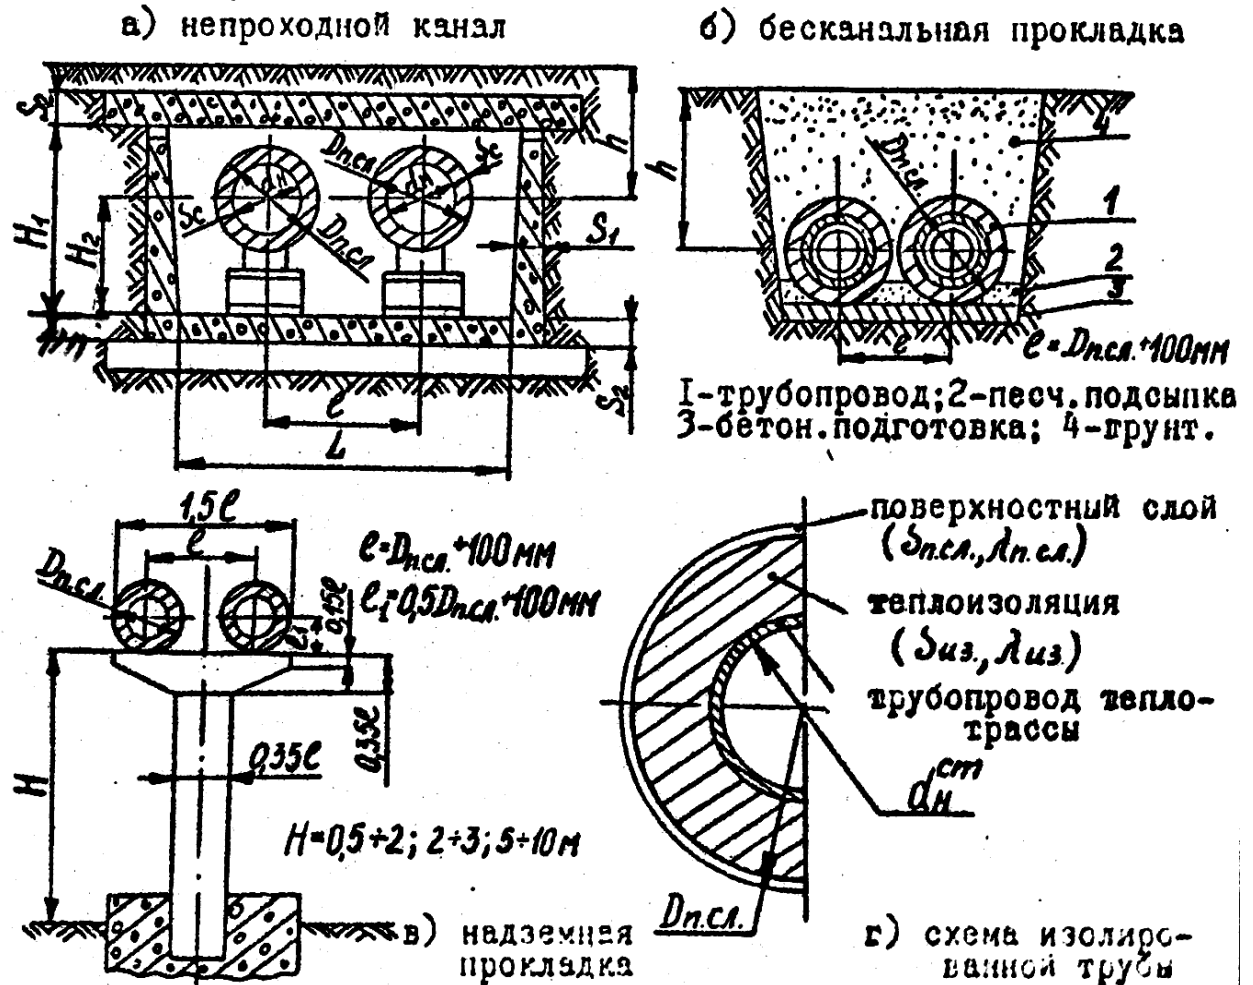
Основные схемы прокладки трубопроводов теплотрассы
